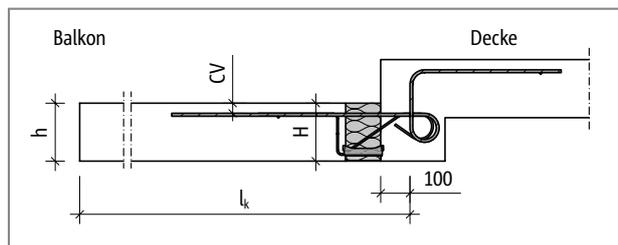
Schöck Isokorb® Typ KXT-HV: Statisches System
